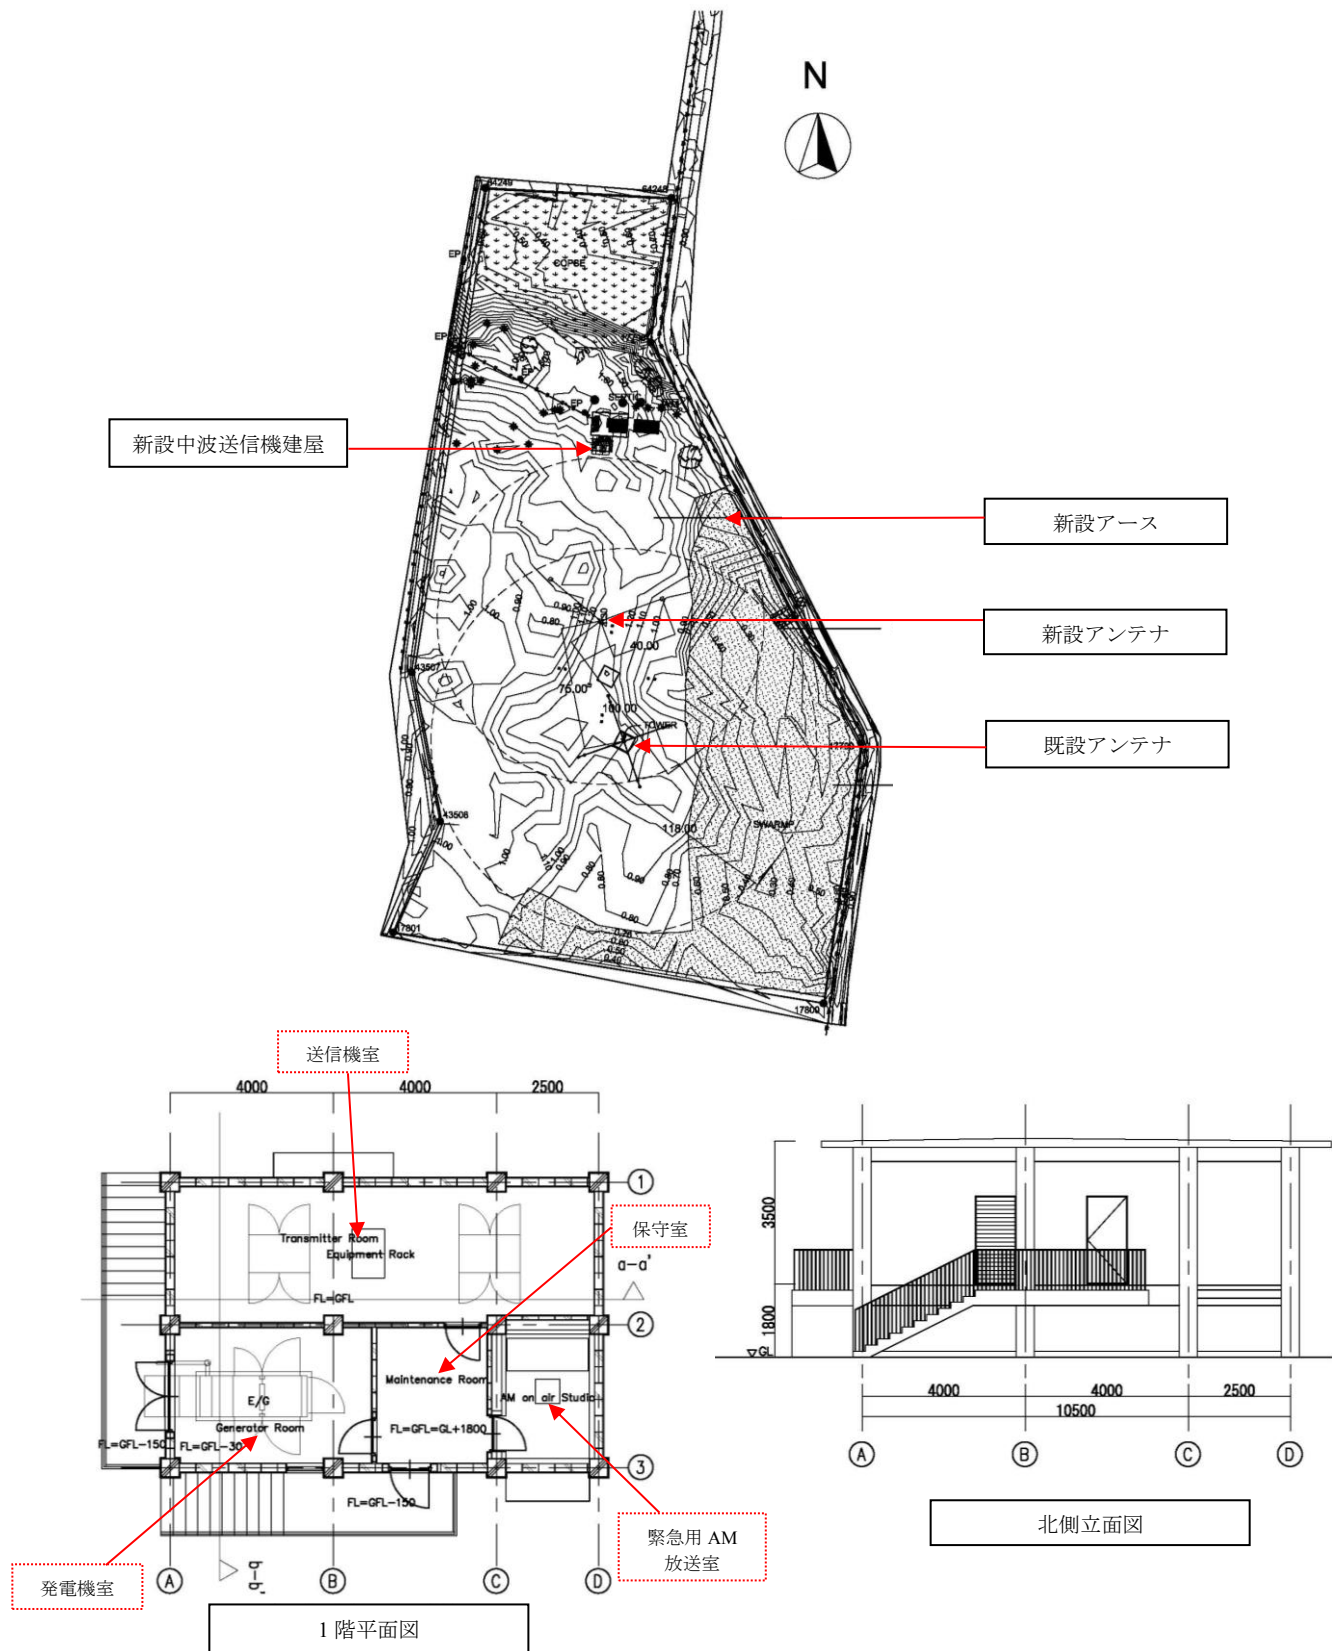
ポプア送信所配置図及び中波送信機建屋平面図・立面図
